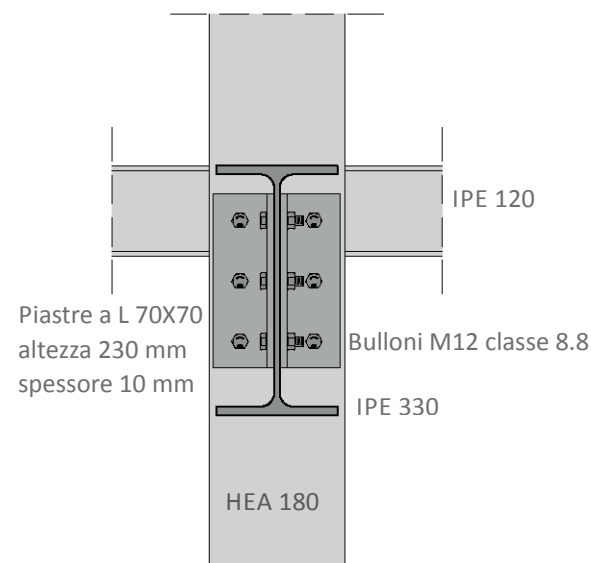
Giunto trave pilastro con la disposizione dei bulloni ipotizzata, sezione verticale
